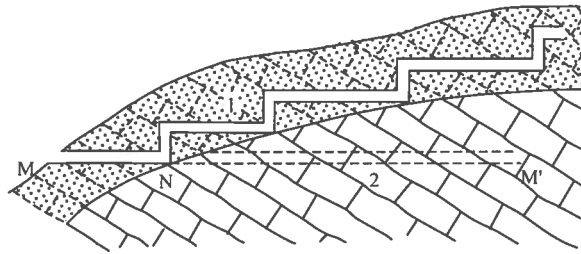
Corretta disposizione di galleria filtrante in terreni disgregati ed alterati superficialmente (1) in cui si sviluppano falde acquifere. La disposizione a gradinata delle gallerie filtranti sfrutta tutta l'area interessata dalla falda. Le gallerie a sviluppo unico sfrutterebbero solo in parte (M-N) la zona acquifera, interessando la restante parte di galleria (N-M') la formazione (2) poco permeabile.
